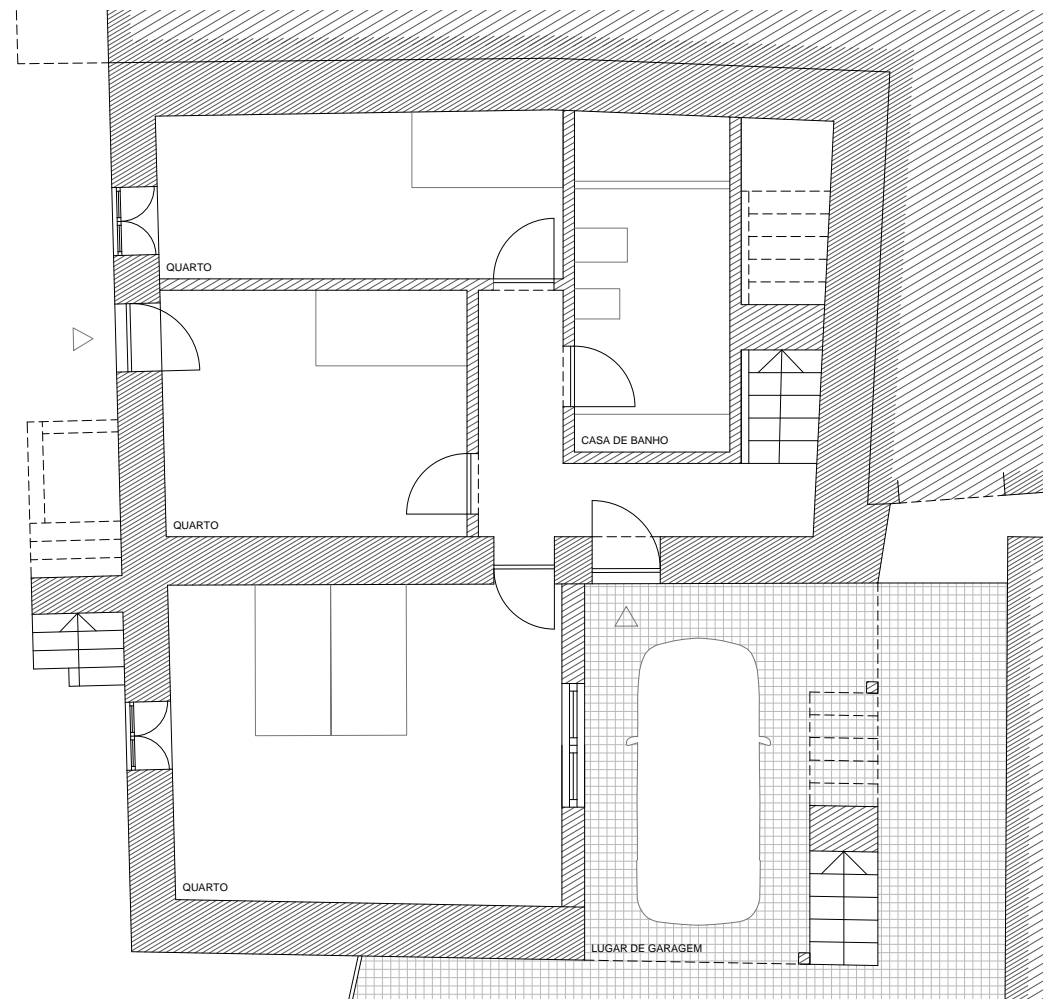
Piso inferior da alternativa com lugar de garagem e escadas para alpendre da Hipótese B. Escala 1:100.
